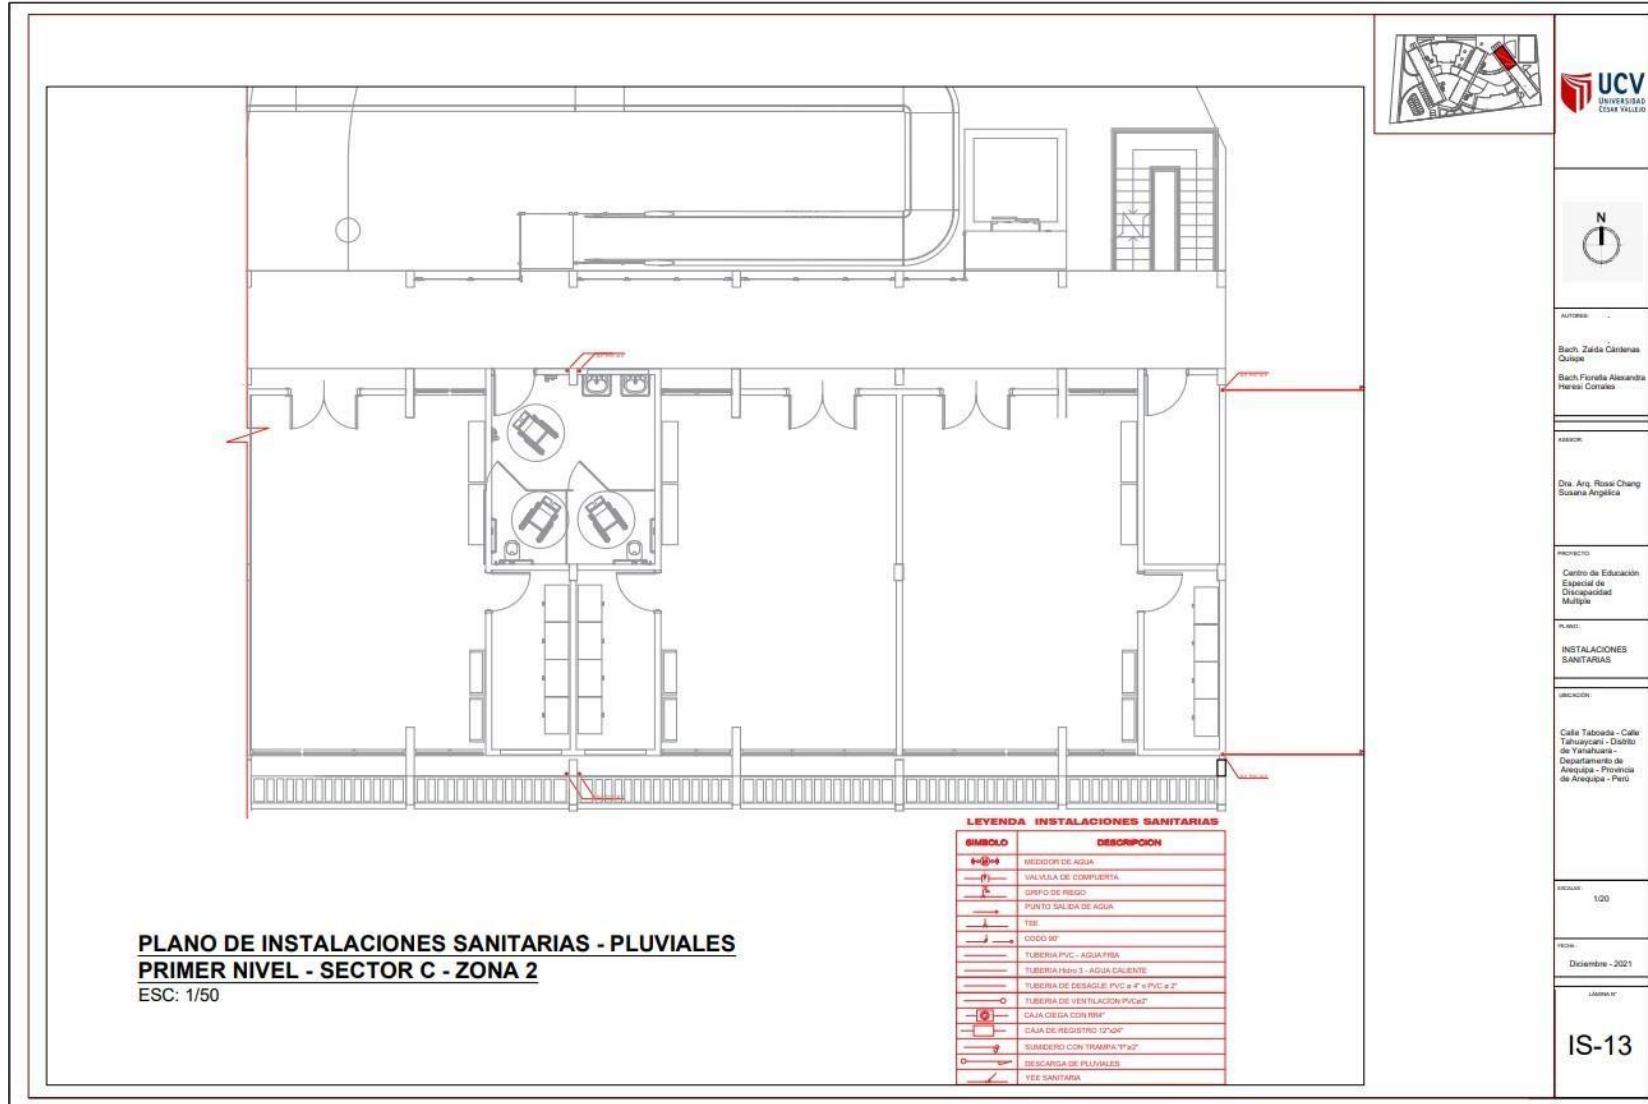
Plano de Instalaciones Pluviales – Primer Nivel - Sector C- Zona 2
